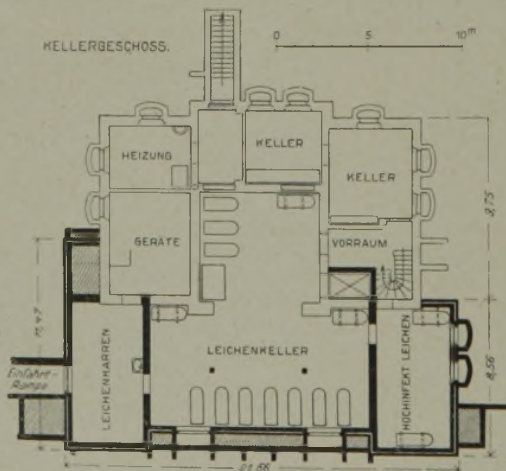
bis 15. Grundrisse von Keller-, Erd- und I. Obergeschoß der Prosektur mit Kapelle. (Maßstab 1 : 400.)
